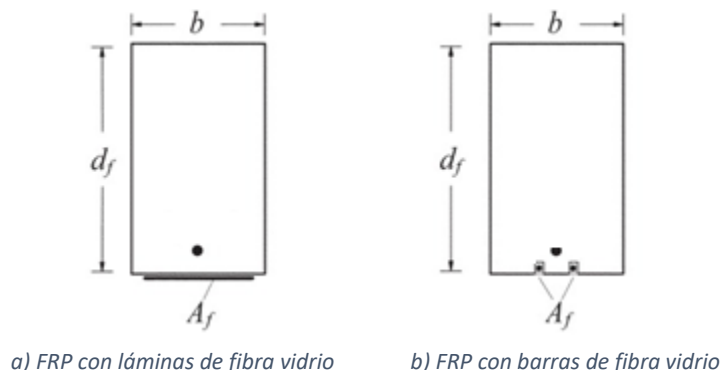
Disposición de FRP sobre viga de hormigón armado.
